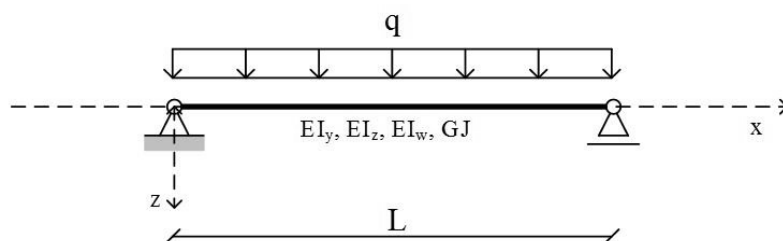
Exemplo 4 - Viga mista simplesmente apoiada
